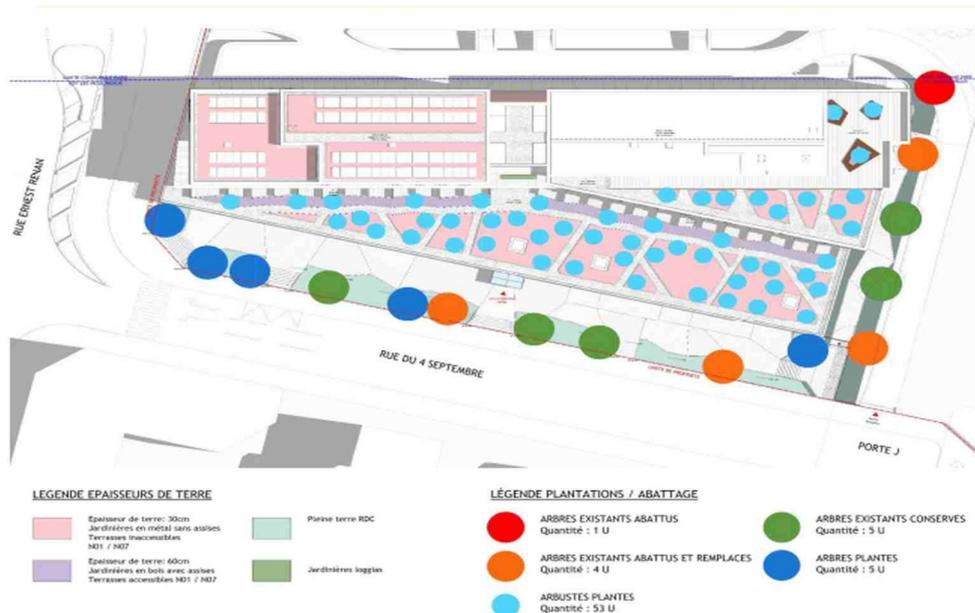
Plan de masse et plantations (source : El tome A p. 25)
